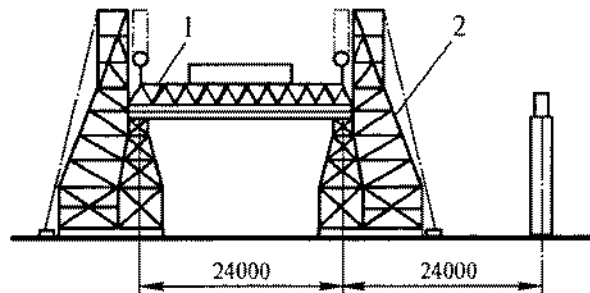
Монтаж блоков покрытия, схема «подъемное устройство — установщик»:
